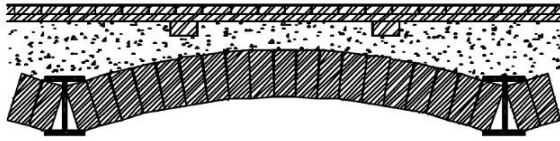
Aufbau Bestandsdecke Parterre Erd- zu Kellergeschoß („Platzdecke“) im Türkenwirt, [Quelle: ERTL (2004)]
